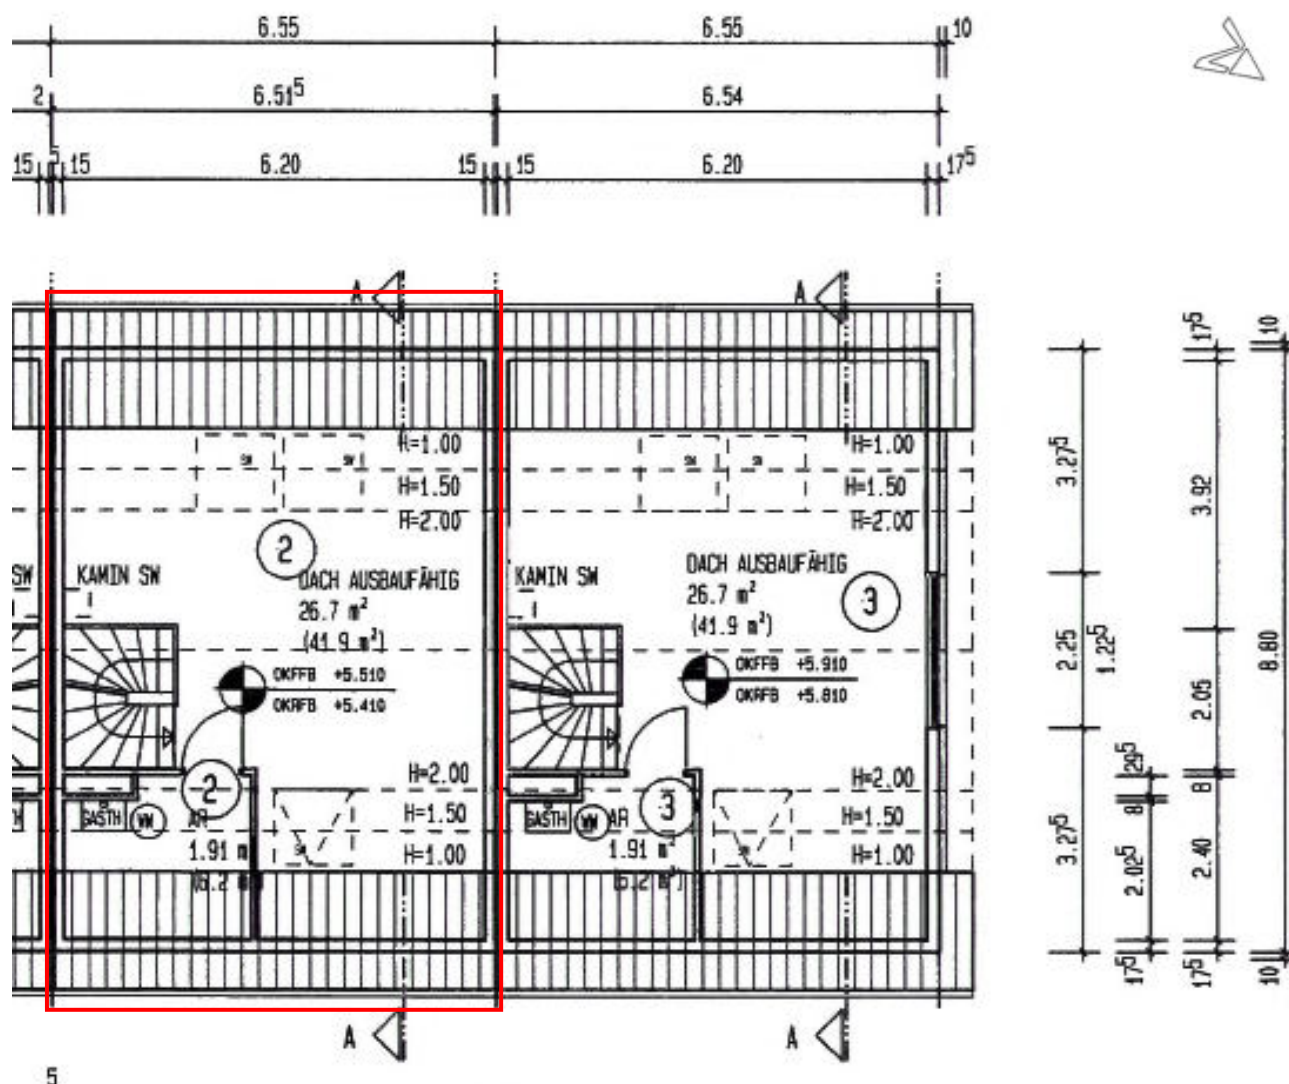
Grundriss Dachgeschoss (Ausschnitt ohne Maßstab); Detail Sondereigentum Nr. 2; Quelle: Bauakte; Roteintragung durch den SV
